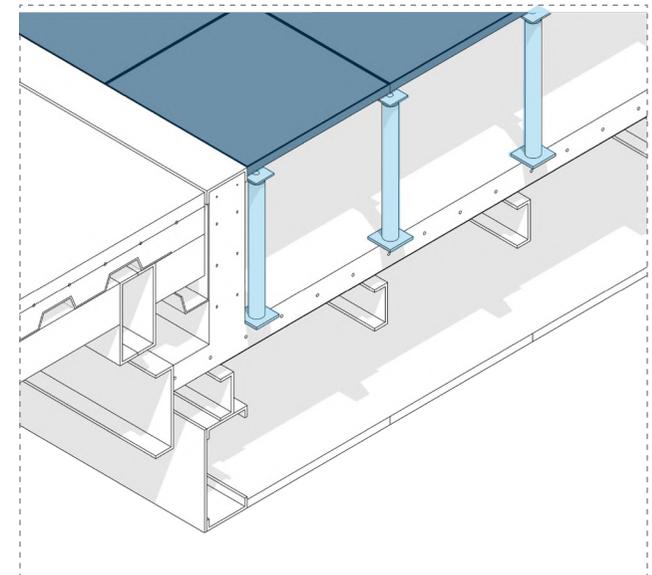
Esquema de elemento perfectible (piso técnico)
